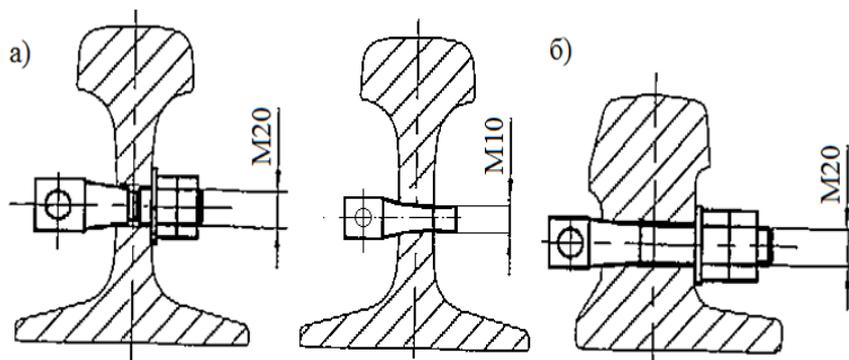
Крепление соединителя к рельсу (а), к сердечнику крестовины (б)
